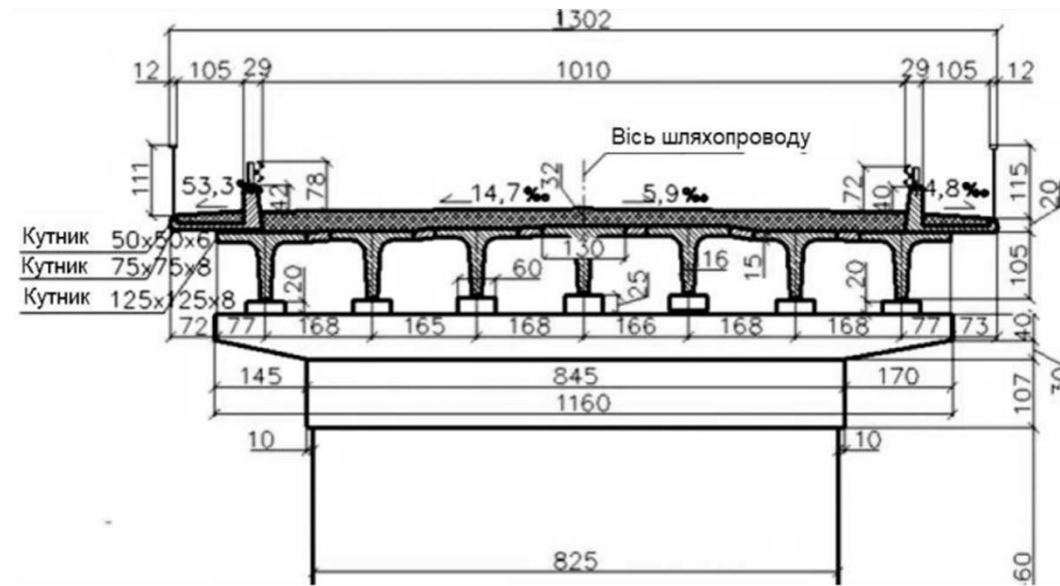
Поперечник залізобетонного шляхопроводу через залізничну дорогу
